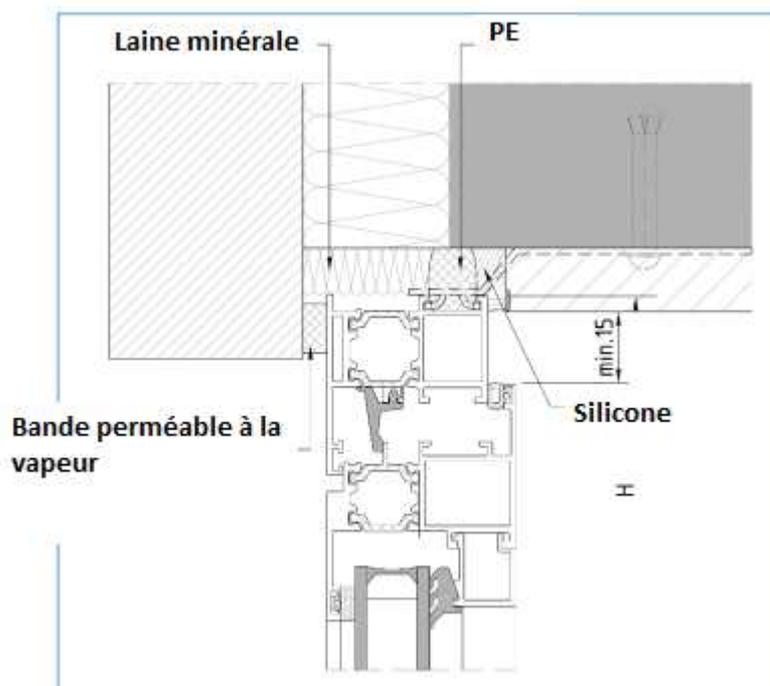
Exemple d'étanchéité du joint du linteau d'une fenêtre en profilés aluminium.
